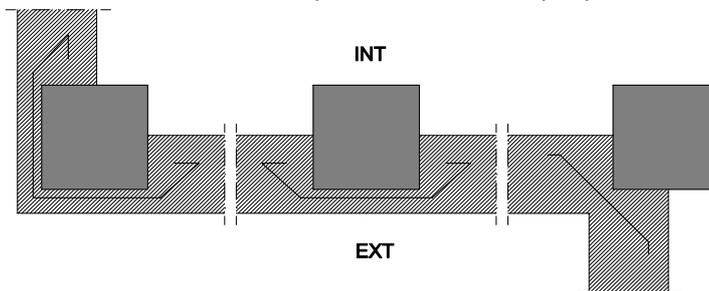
Ejemplo de encuentro de la fachada con los pilares
